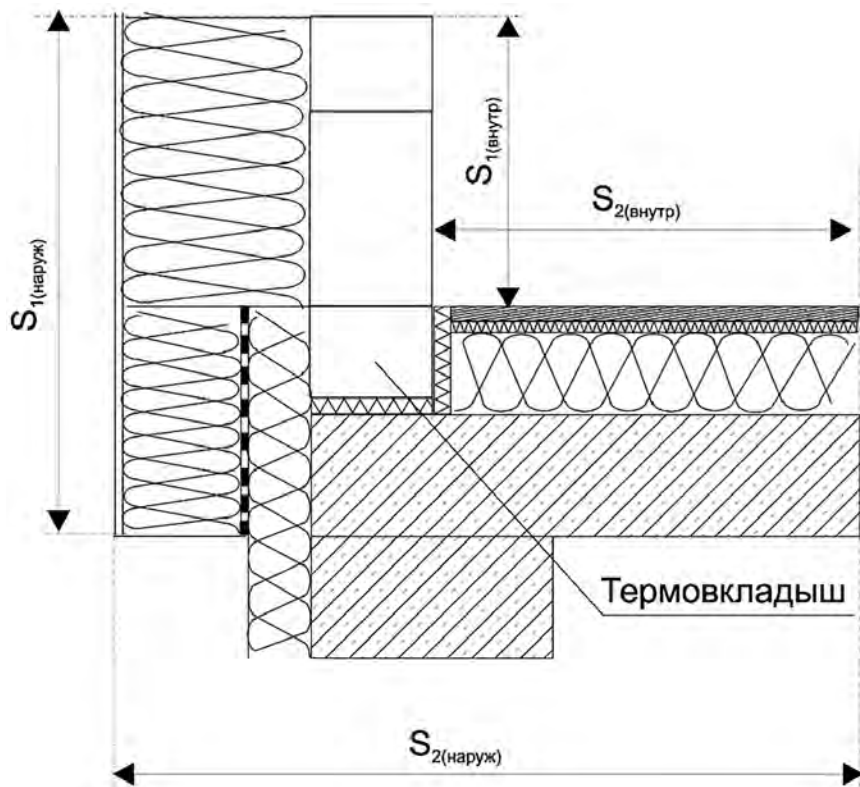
Пример соединения каменной стены с утепленной фундаментной плитой без «теплого мостика»
